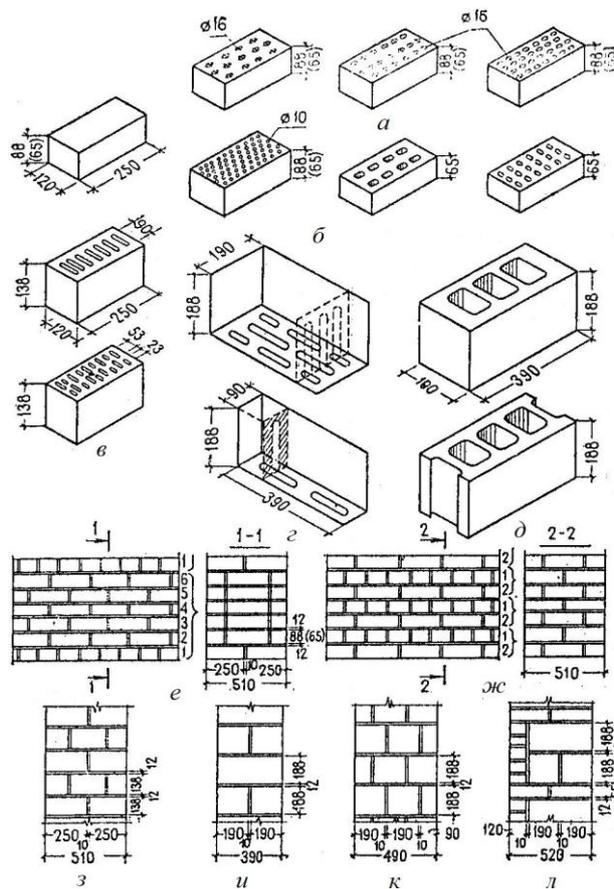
Материалы и типы сплошных кладок наружных каменных стен:
